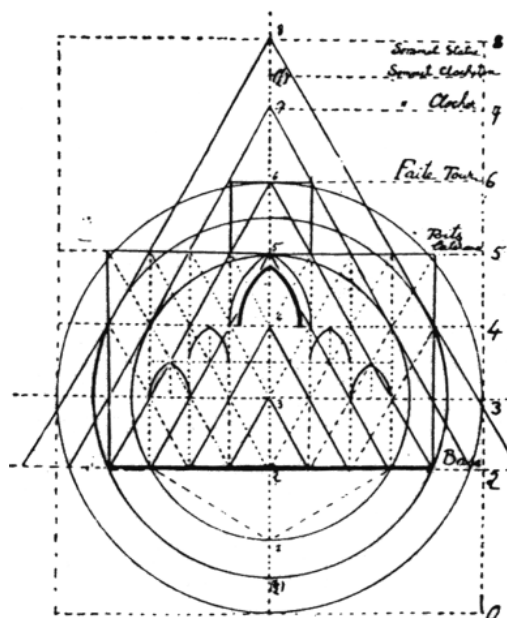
Fachada de la Catedral de Milán, donde se aprecia el triángulo como base constructiva, según las construcciones «*ad triangulum*».
